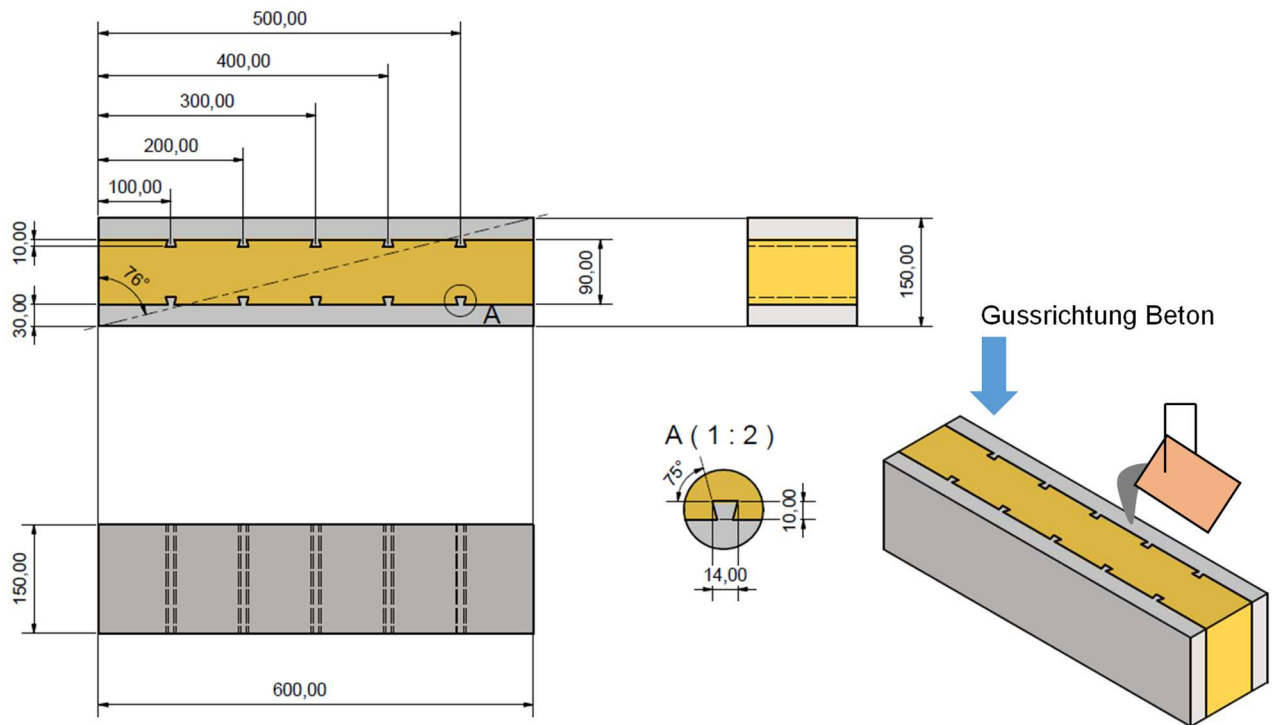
Technische Zeichnung zur Herstellung der Balkenproben, Maße in Millimetern
